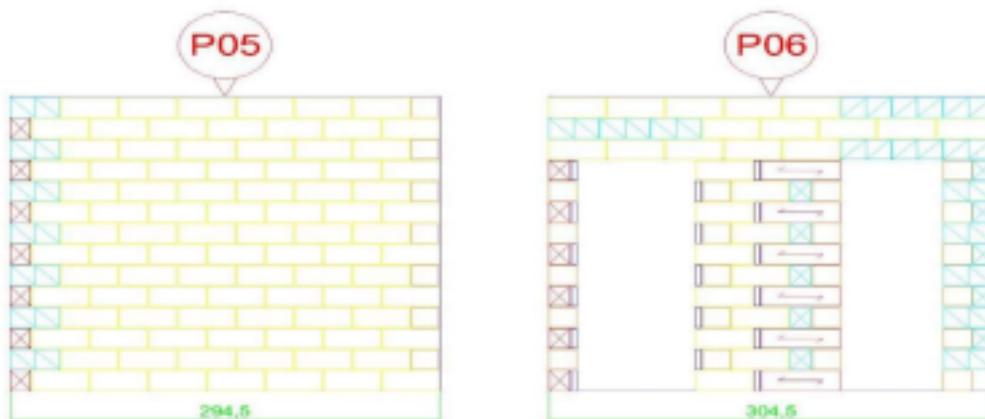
Modulação dos blocos estruturais de concreto do projeto executado
